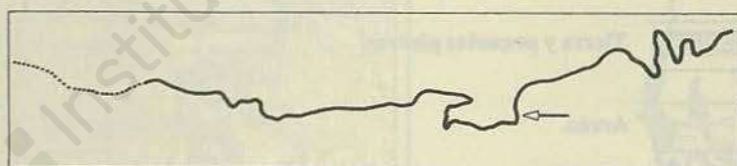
Calzada del Puerto del Pico. Cata 4. Perfil Norte/Sur.
